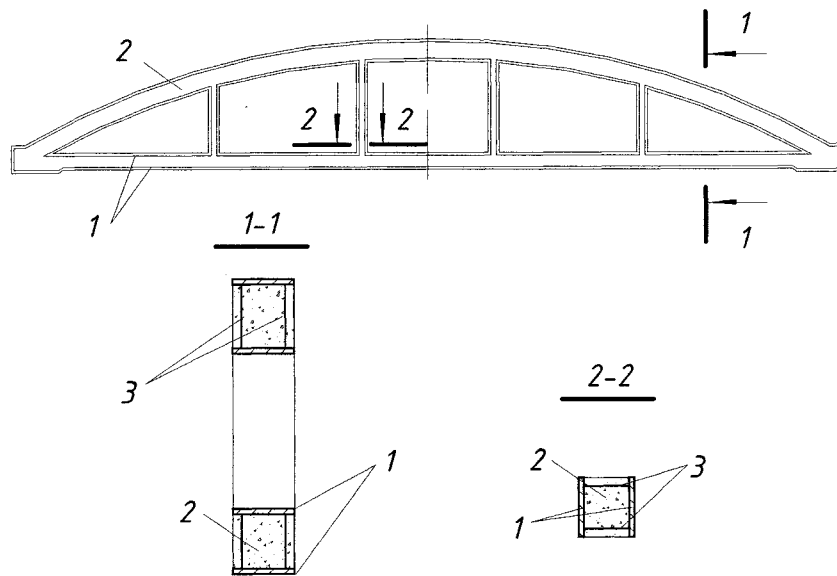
Сталезалізобетонна арка із зовнішнім листовим армуванням
